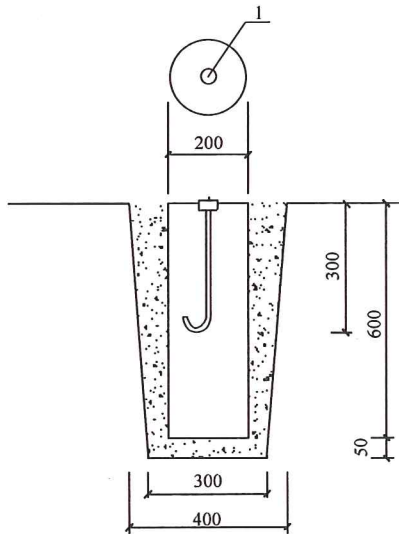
一二级控制点预制混凝土标石造埋规格 (mm)
